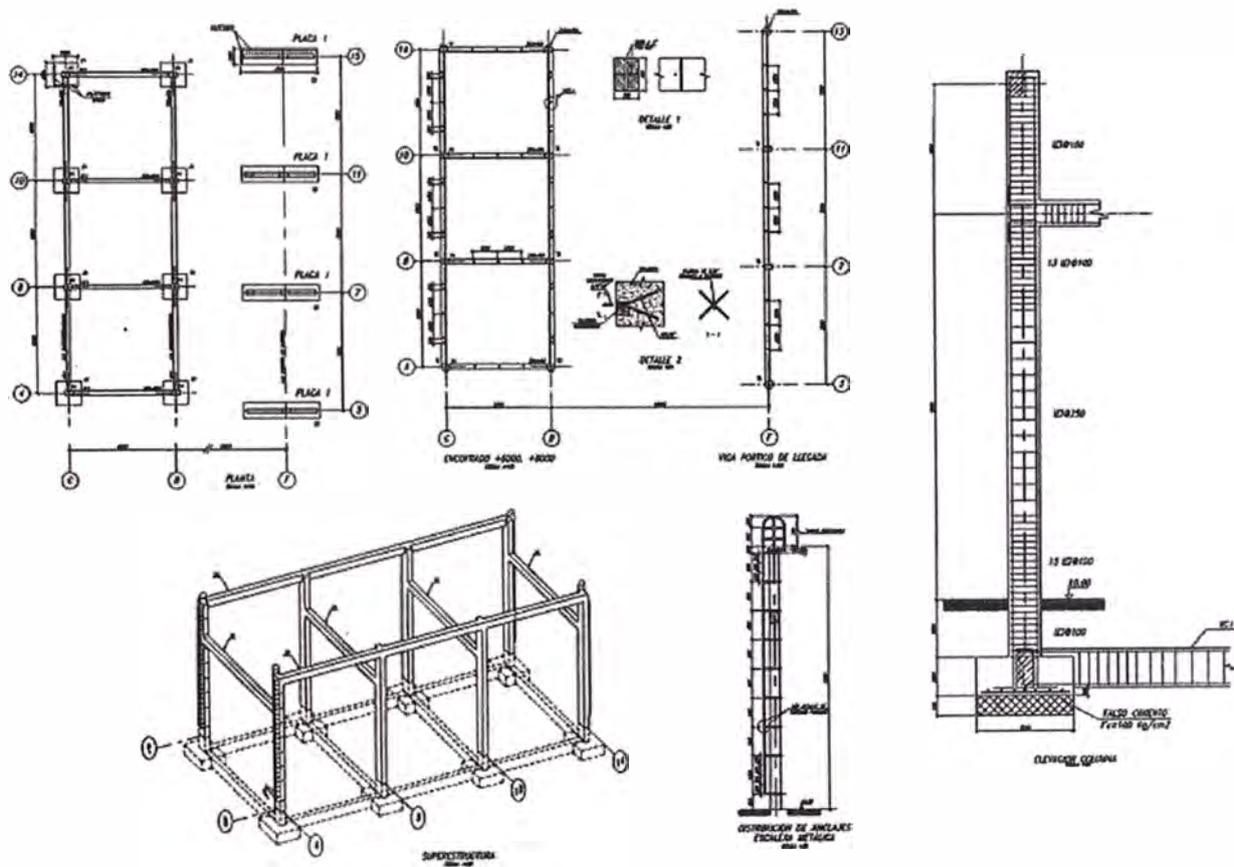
Diseño de Superestructura de Concreto Armado
